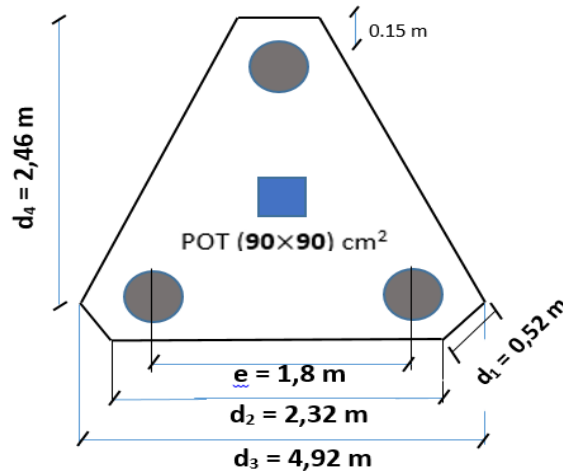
Dimensions finales de la semelle sur trois pieux
